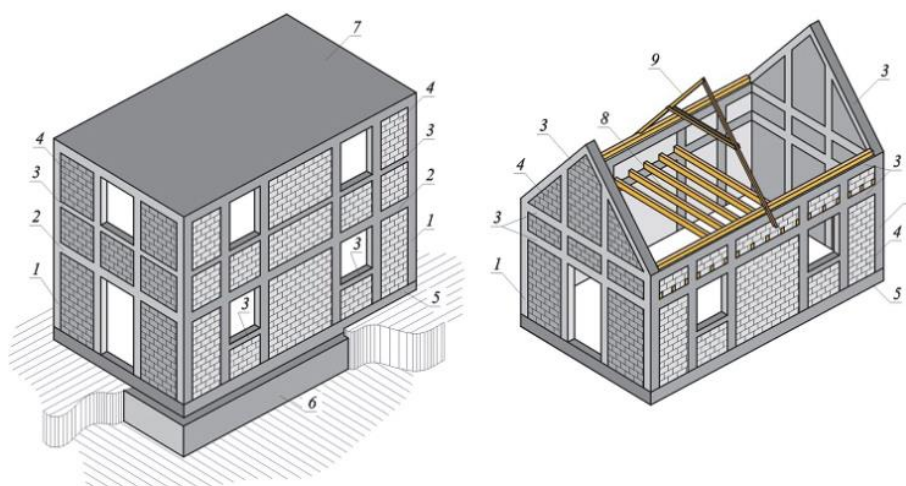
Схема каркасно-каменных зданий [8]:
